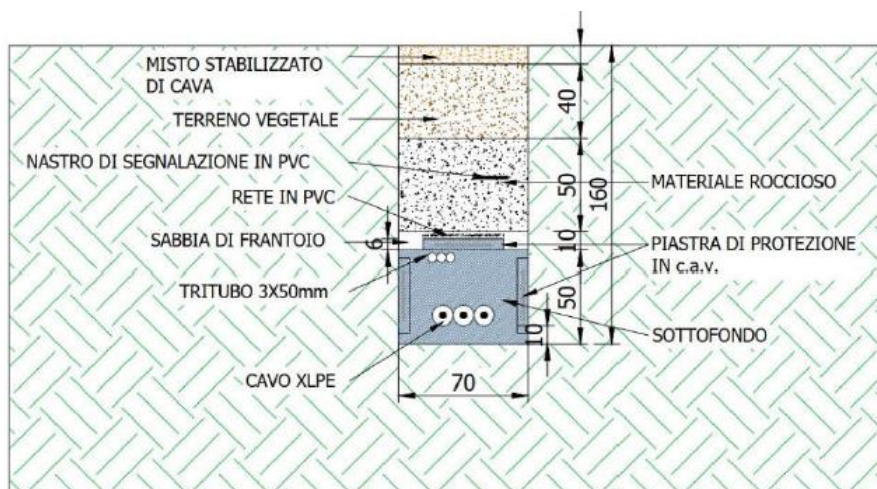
Sezioni tipiche posa cavi AT su strade brecciate
